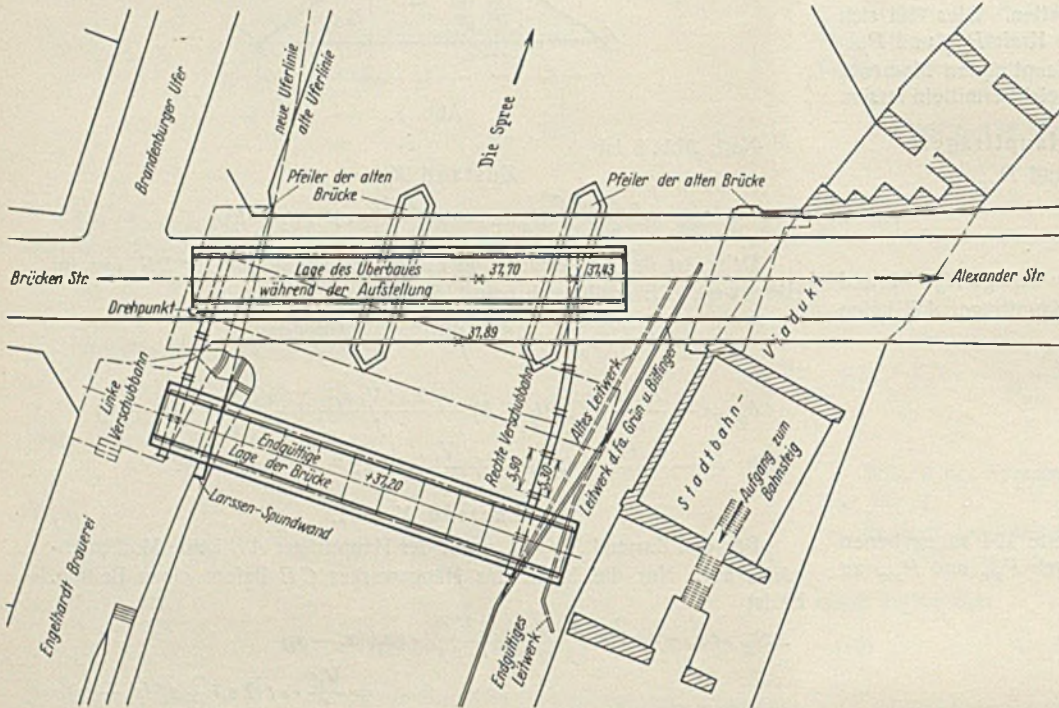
Lageplan für Aufstellung und endgültige Lage des Überbaues.
